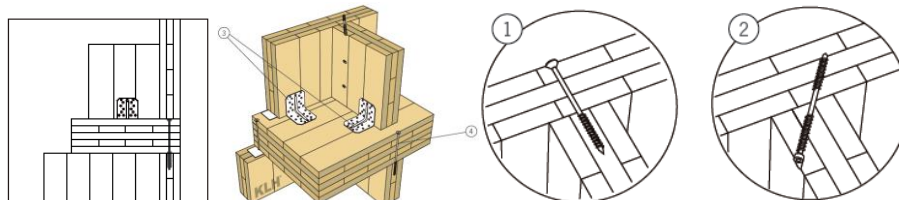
Parede exterior com ligação a parede interior e pavimento intermédio (KLH Massivholz GmbH, 2013b).
